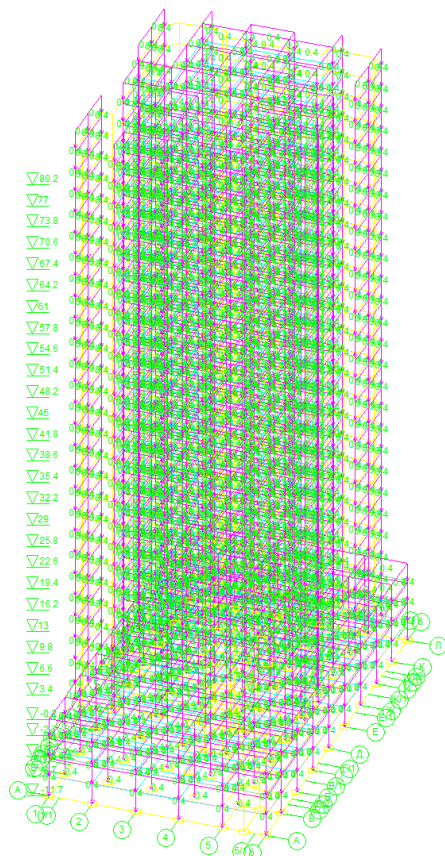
Нагрузка от собственного веса конструкций
